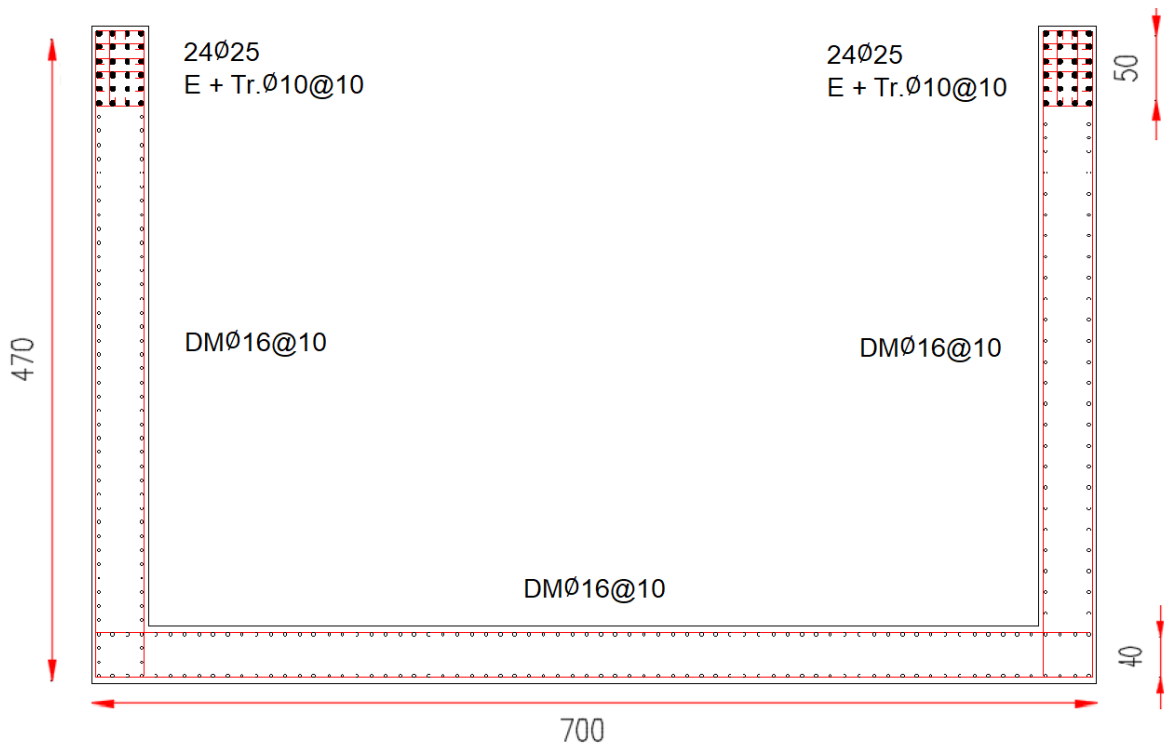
Disposición de armadura muro C modelo de 30 pisos.
